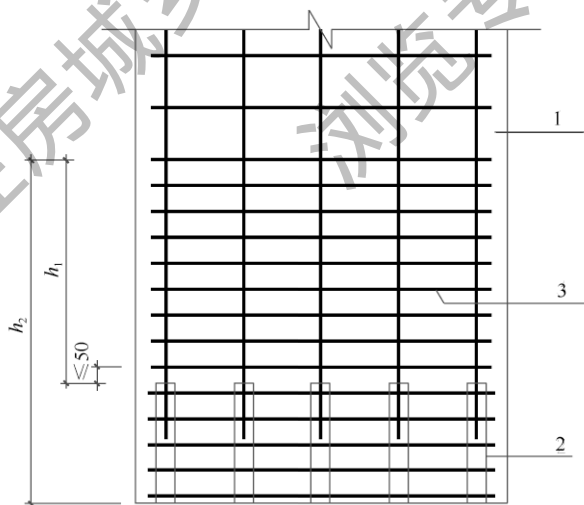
灌浆套筒连接处箍筋加密区的构造示意（单位：mm）
